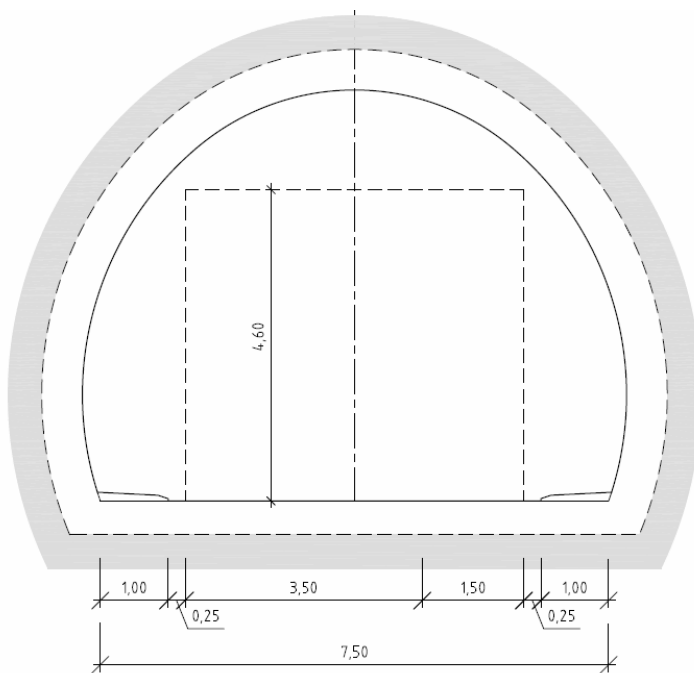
Skjematisk tunnelprofil, vist med eksempel på veggelement og føringskant av betong.
